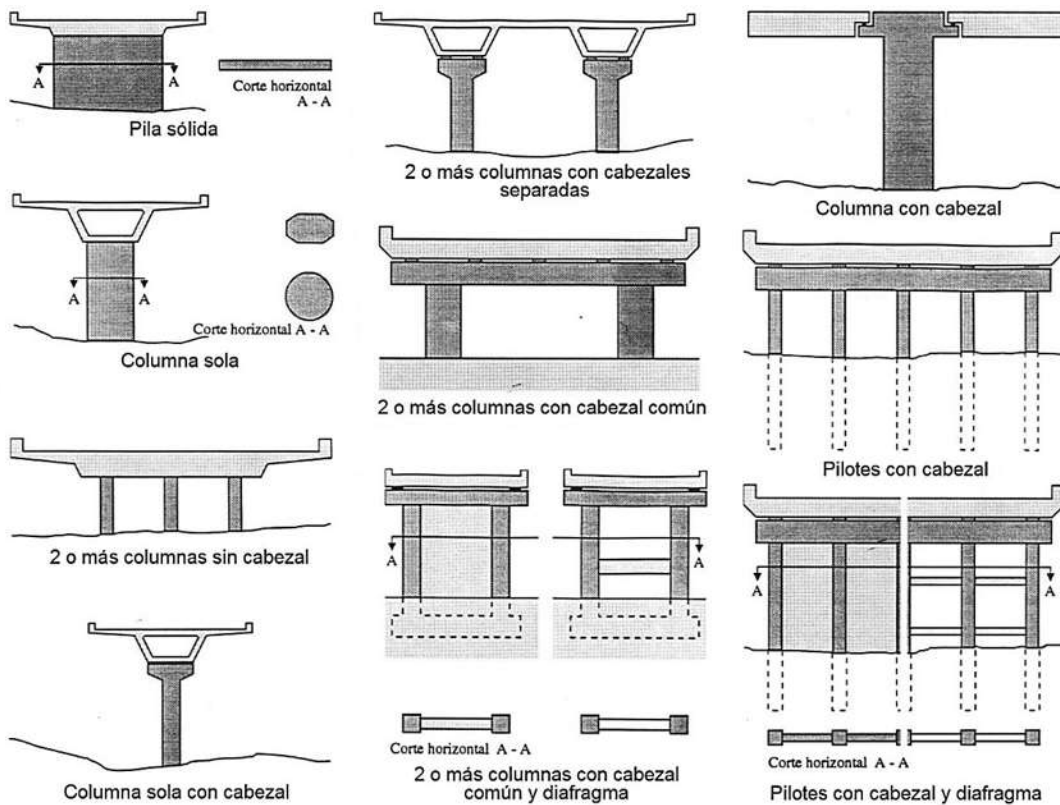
Tipos de pilas de puentes (SIPUMEX, 2011).
